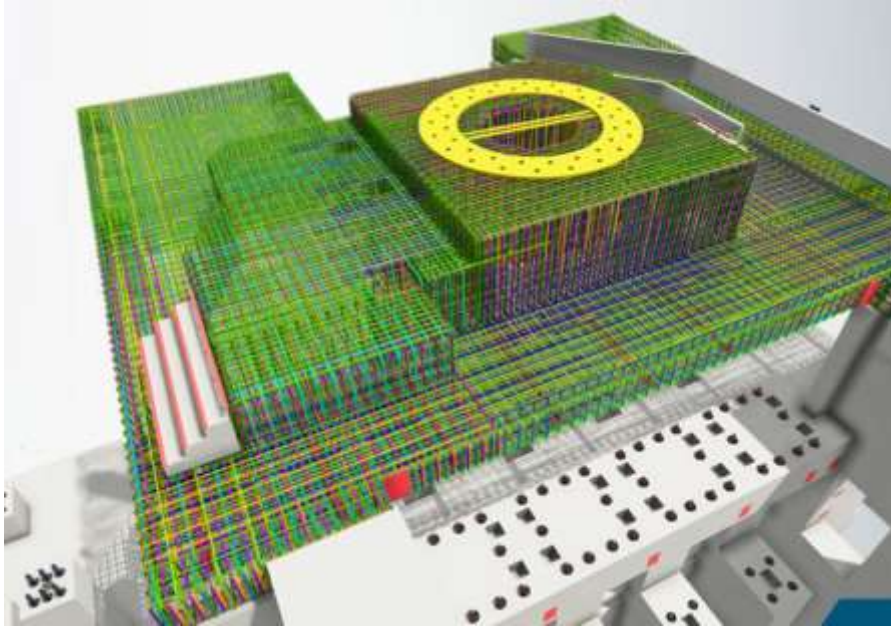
Planos de instalación de una viga – TERMINALES PORTUARIOS
